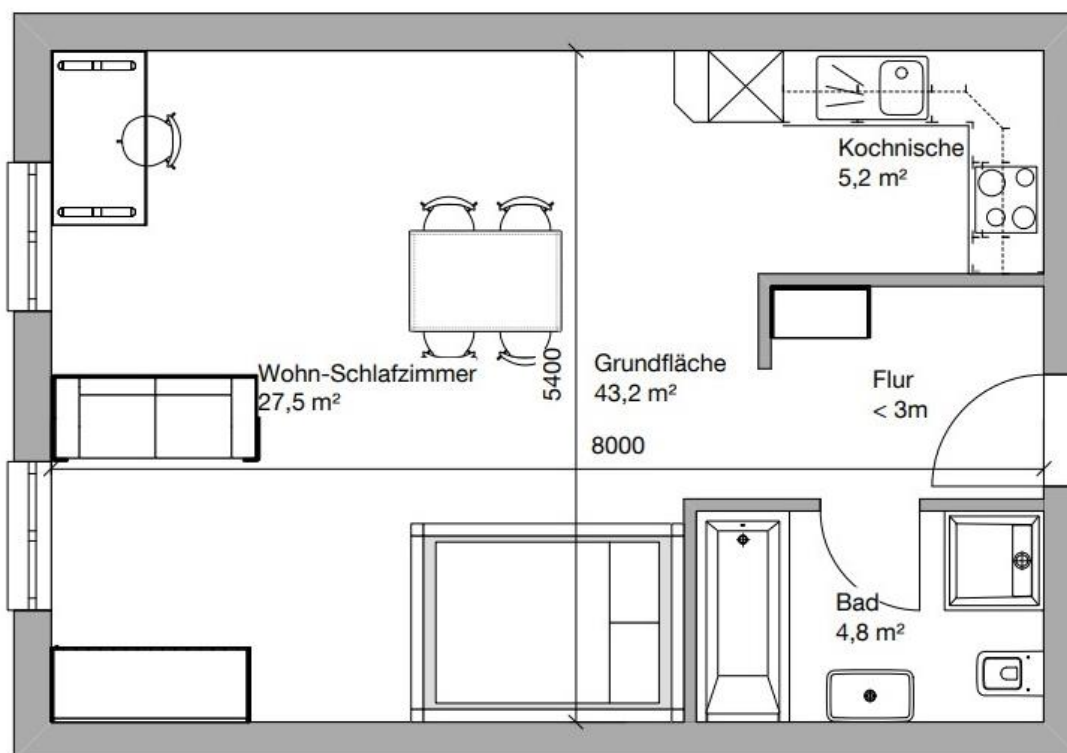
Grundriss Einzimmerwohnung¹⁹
